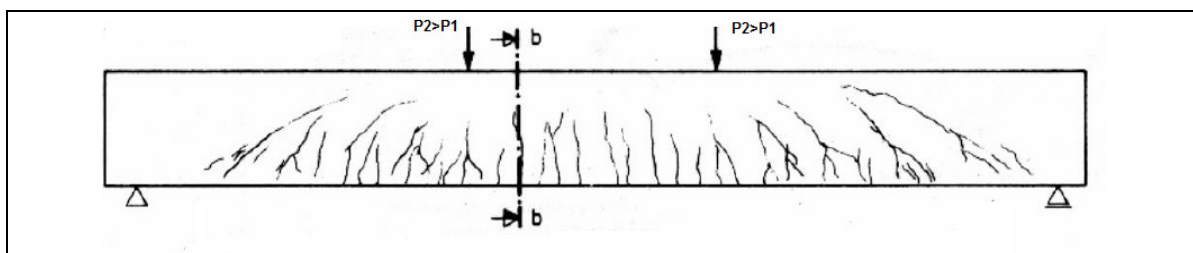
Fissuras de flexão e fissuras de cisalhamento pouco antes da ruptura (SILVA; MELO, 2005).
